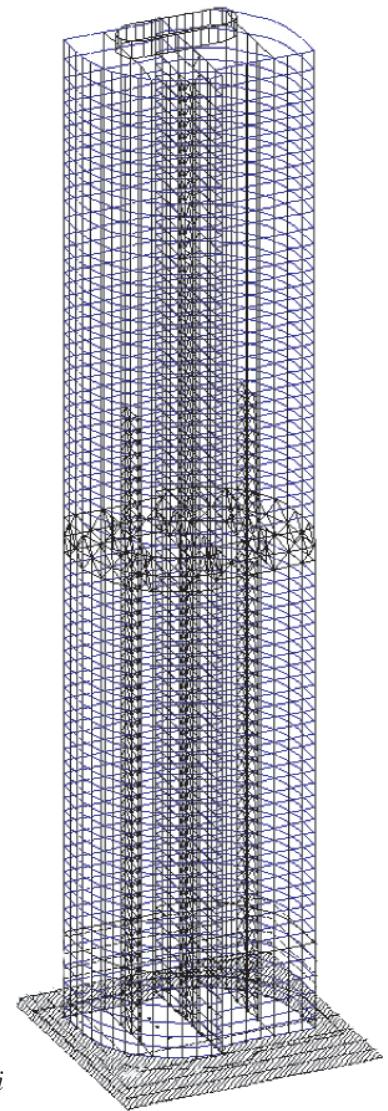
Схема розташування аутригерного поверху в багатоповерховій будівлі
